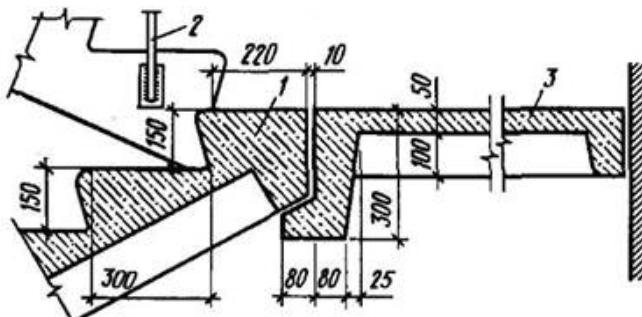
Узел сопряжения лестничного марша и площадки: 1 – марш, 2 – стойка ограждения, 3 – площадка
